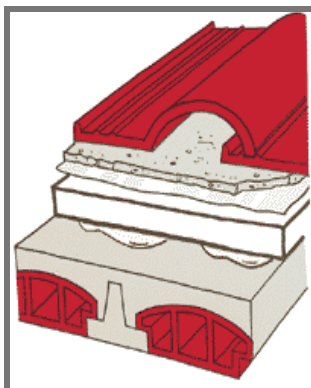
Sistema de isolamento na face superior <sup>[15]</sup>
